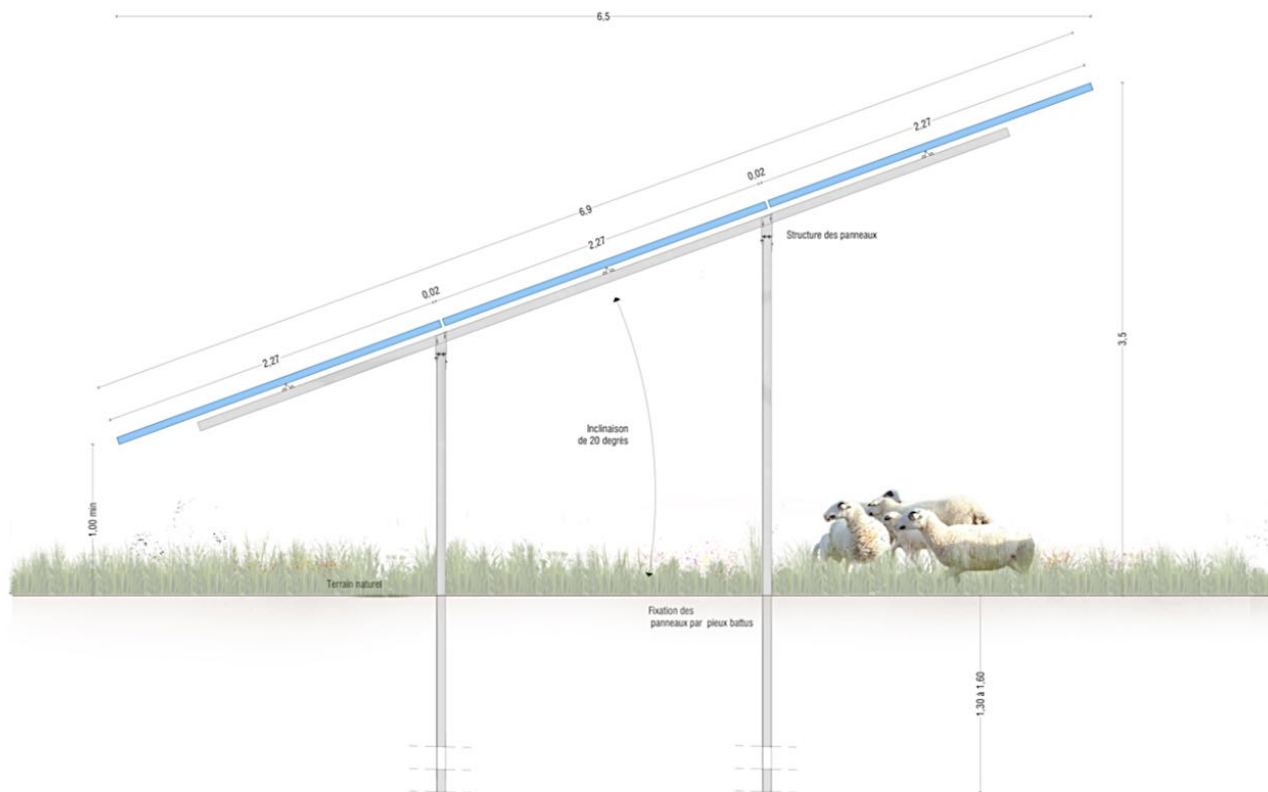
Coupe latérale d'une rangée de panneaux. (Source : PHOTOSOL)
